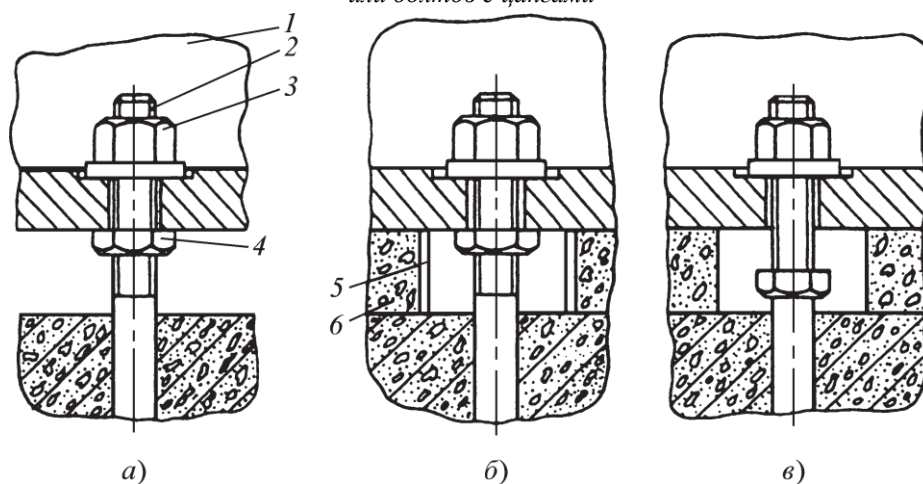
Схемы регулирования положения оборудования на установочных гайках без упругого элемента: а — установка в проектное положение; б — подливка оборудования; в — отвинчивание установочной гайки перед закреплением
